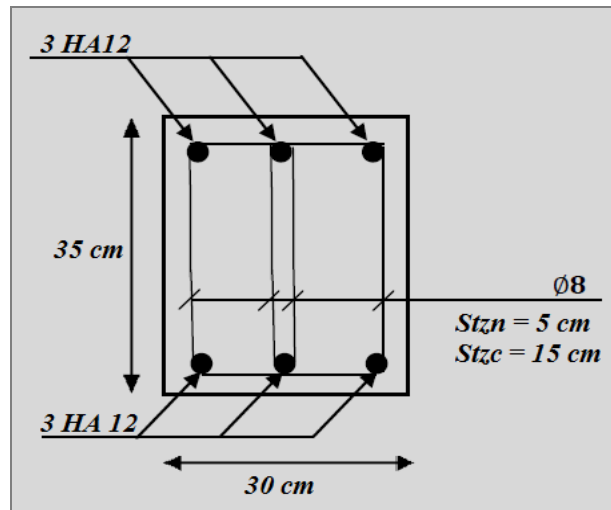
Schéma de ferrailage de poutre sekunder.
